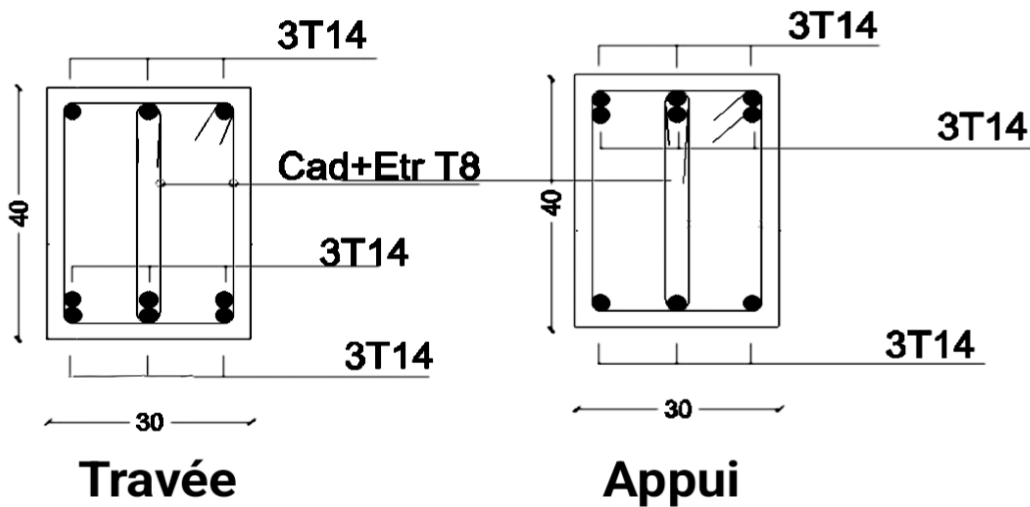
Ferraillage des poutres principales du Terrasse.
